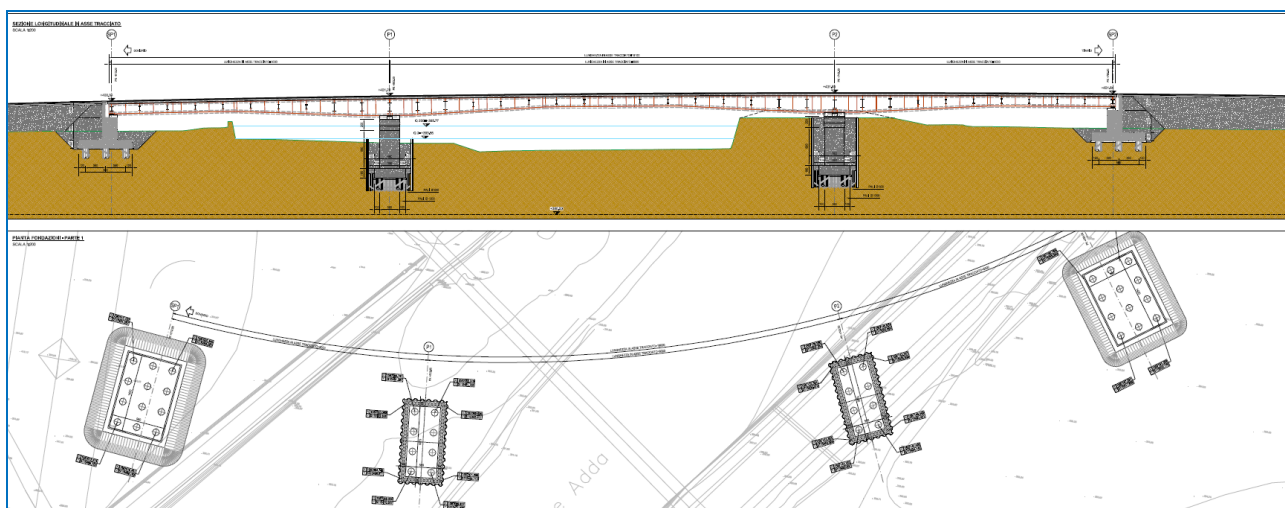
planimetria e sezione del ponte di Stazzona, opere in fondazione per garantire il passaggio di una portata con tempo di ritorno 2 anni (vista valle monte)
